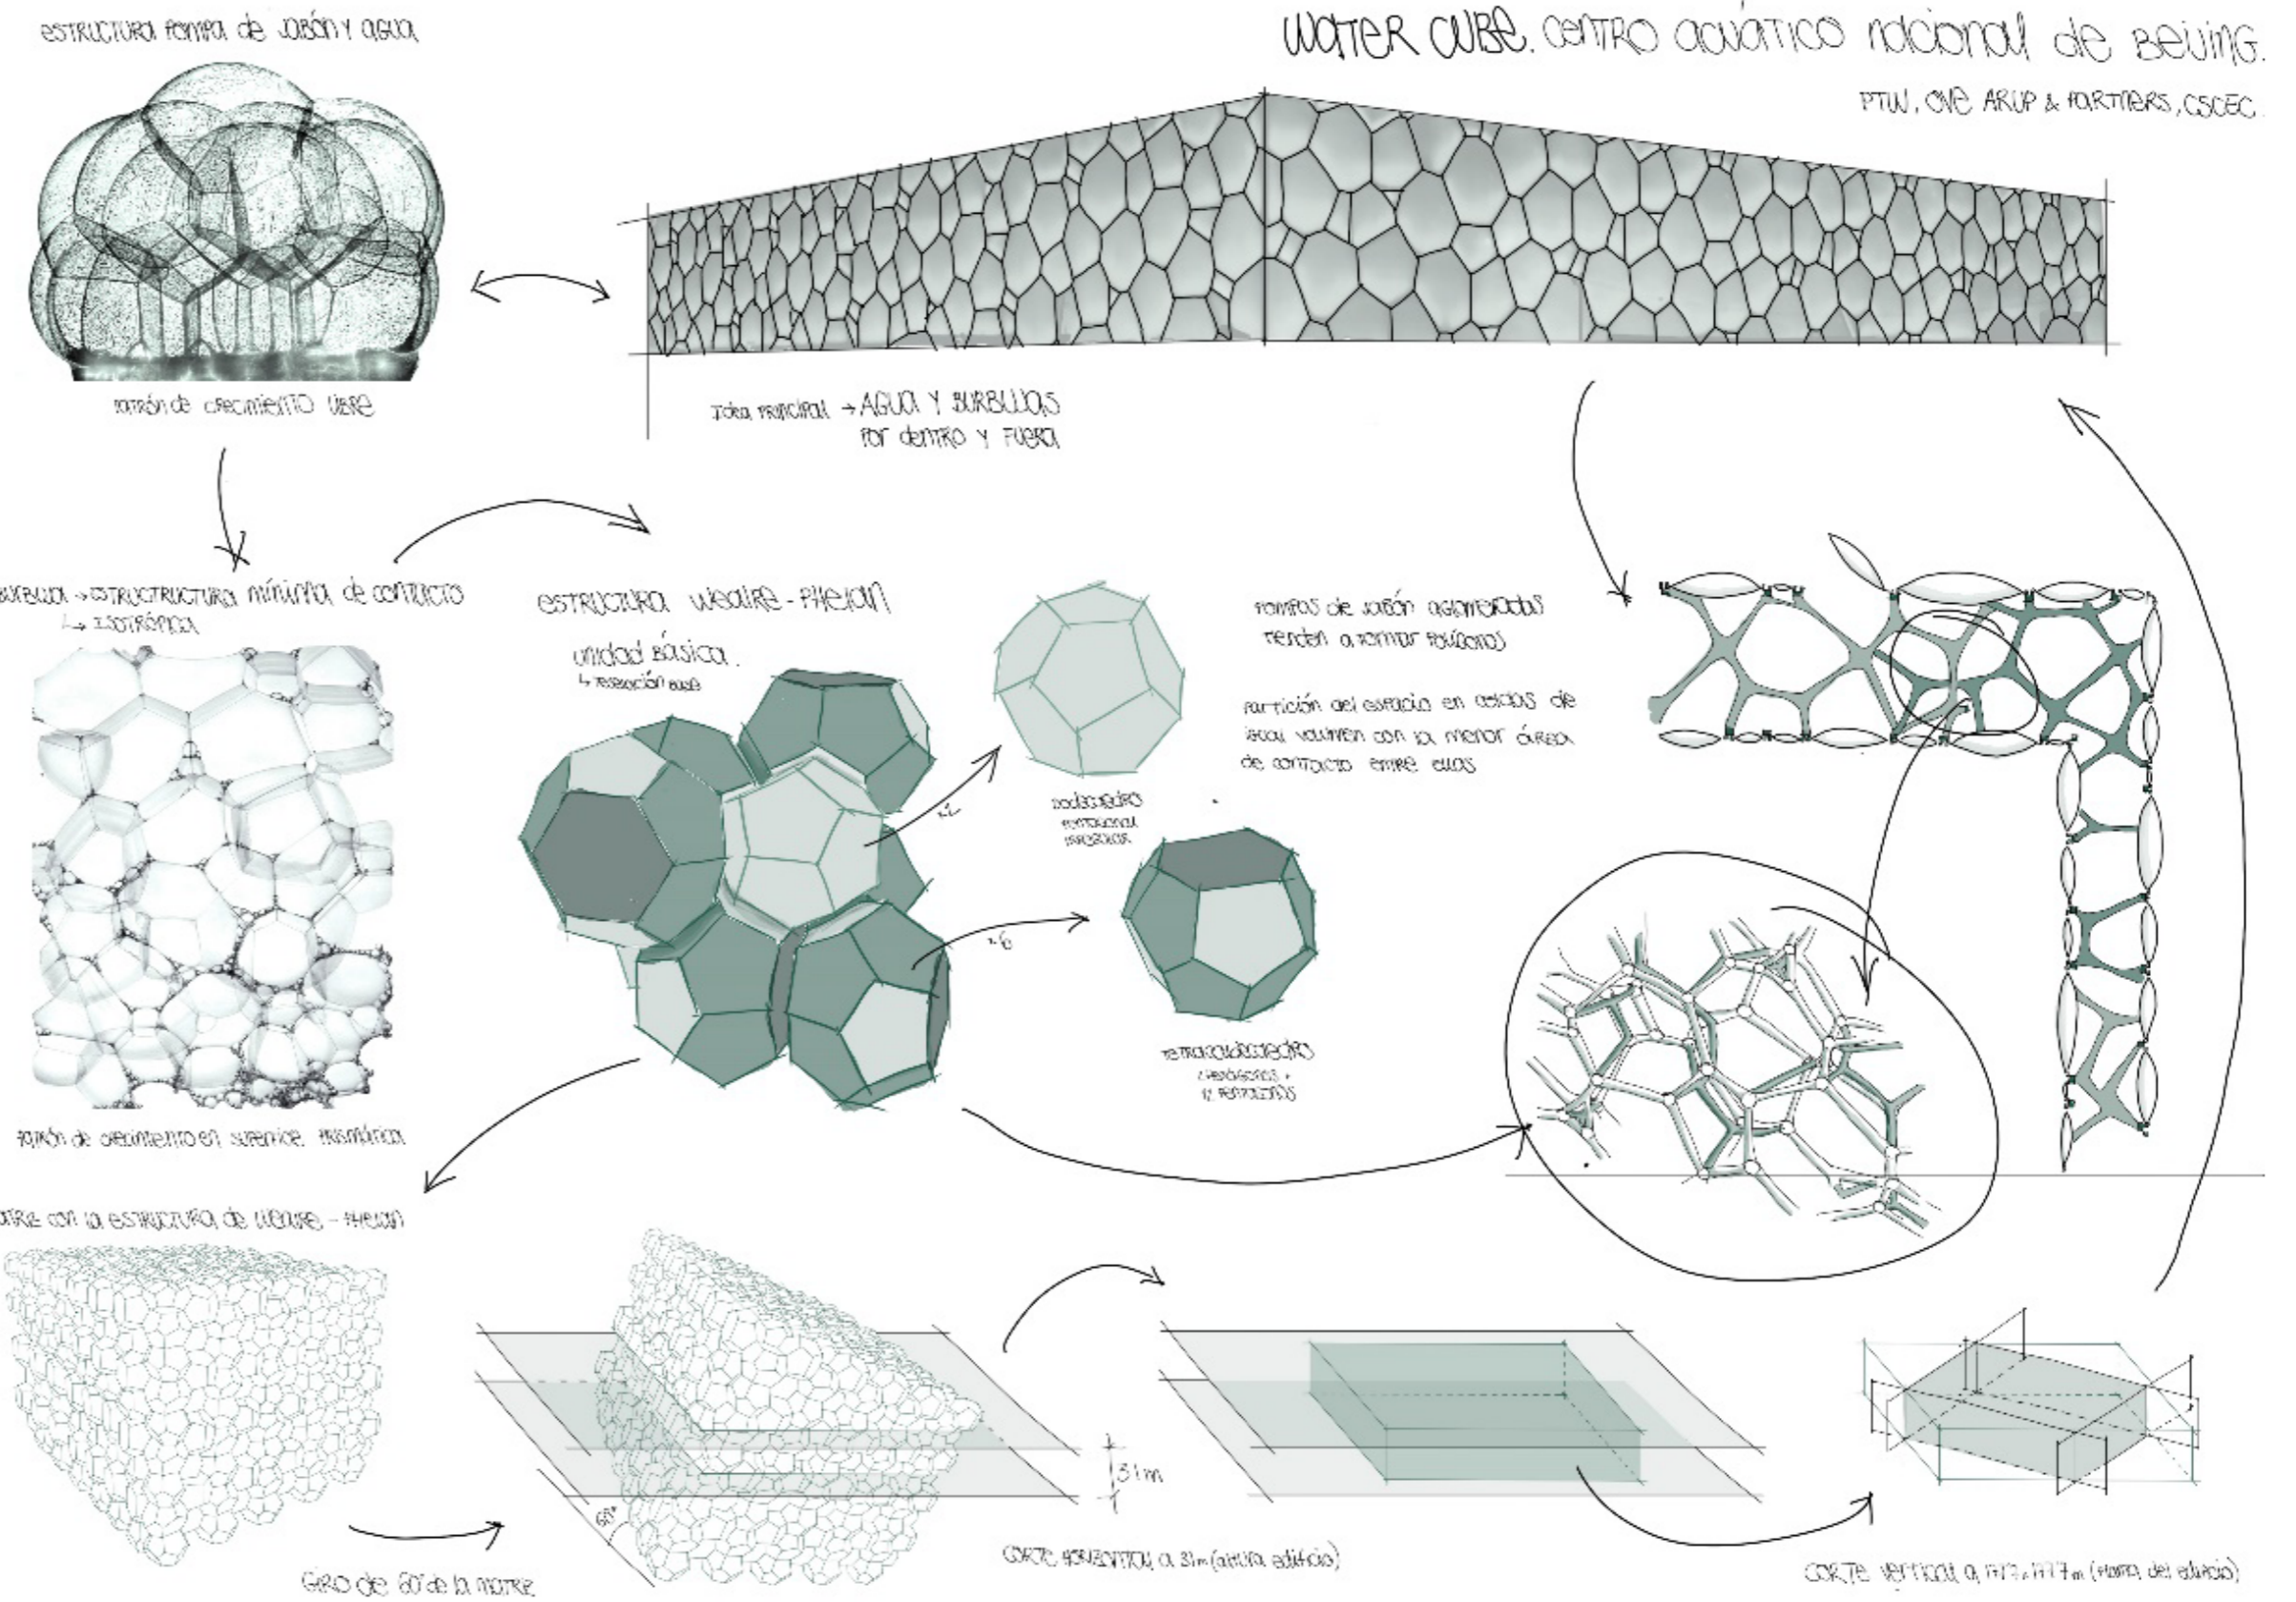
Explicación estructural de Water Cube, las pompas de jabón y la estructura de Weaire-Phelan. Elaboración propia.
